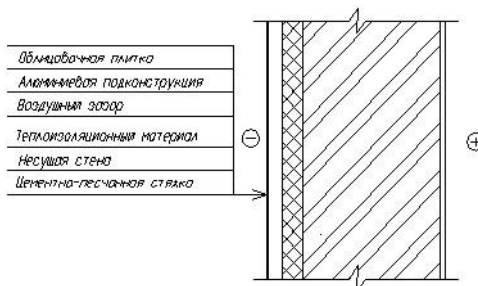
Схема утепления с наружной стороны системой вентилируемого фасада
